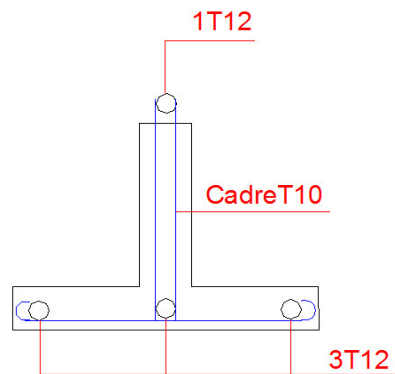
Schéma de ferrailage de la poutrelle.
